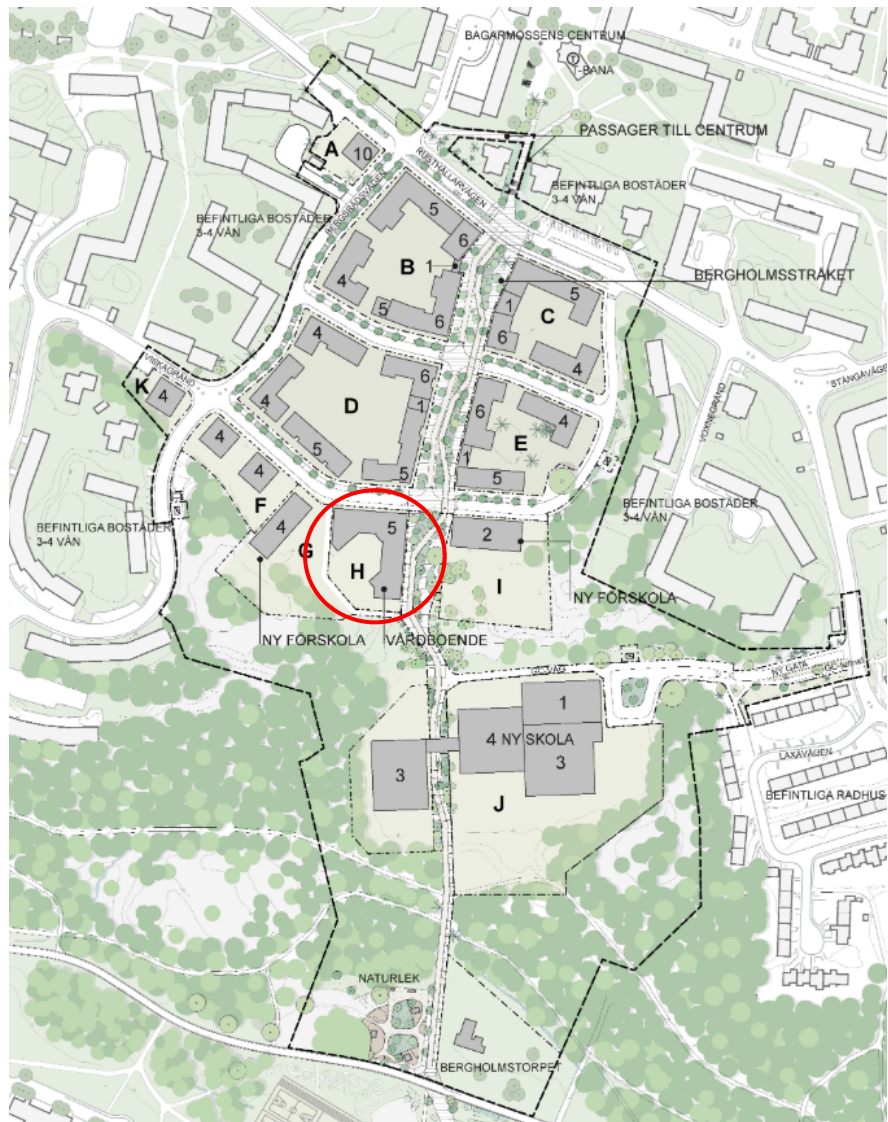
Överblicksbild av planområdet. Det planerade vård- och omsorgsboendet är inom kvarter H.
